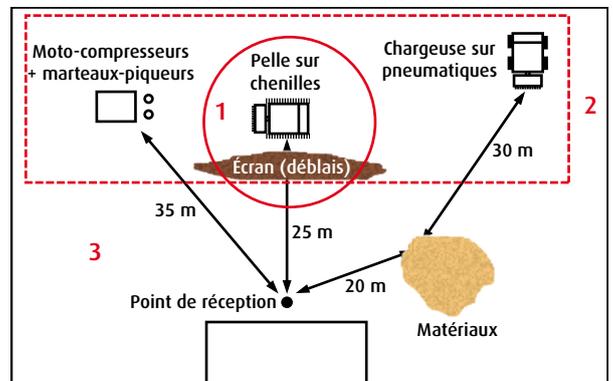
Schéma d'un exemple de travaux de terrassement en vue de construction d'un immeuble [10]
